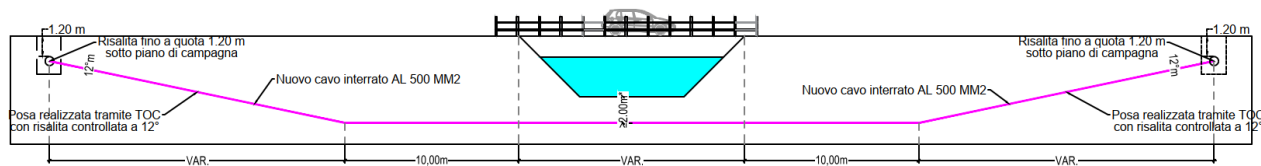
profilo longitudinale tipo dell'attraversamento in subalveo tramite TOC.
